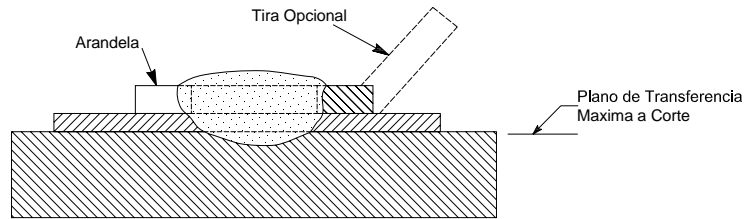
Puntos de soldadura por arco usando arandelas
